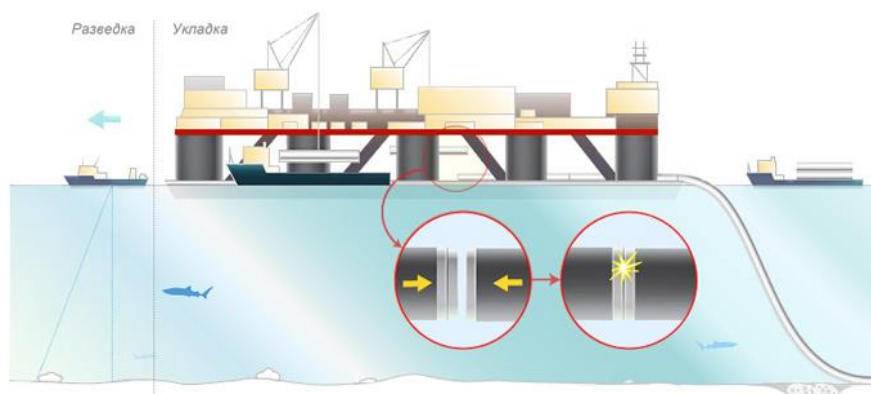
Схема укладки трубопровода при помощи судов-трубоукладчиков
